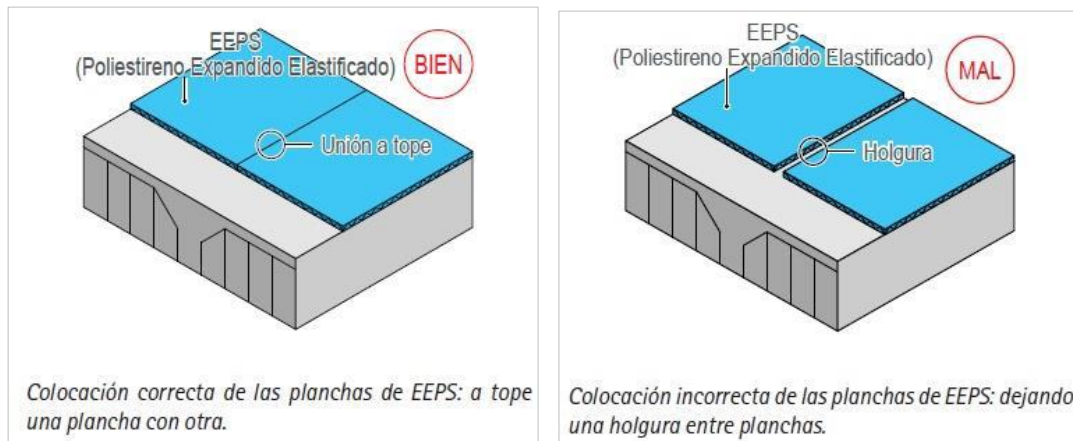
Ejecución correcta/incorrecta de la colocación de las planchas de EEPS
